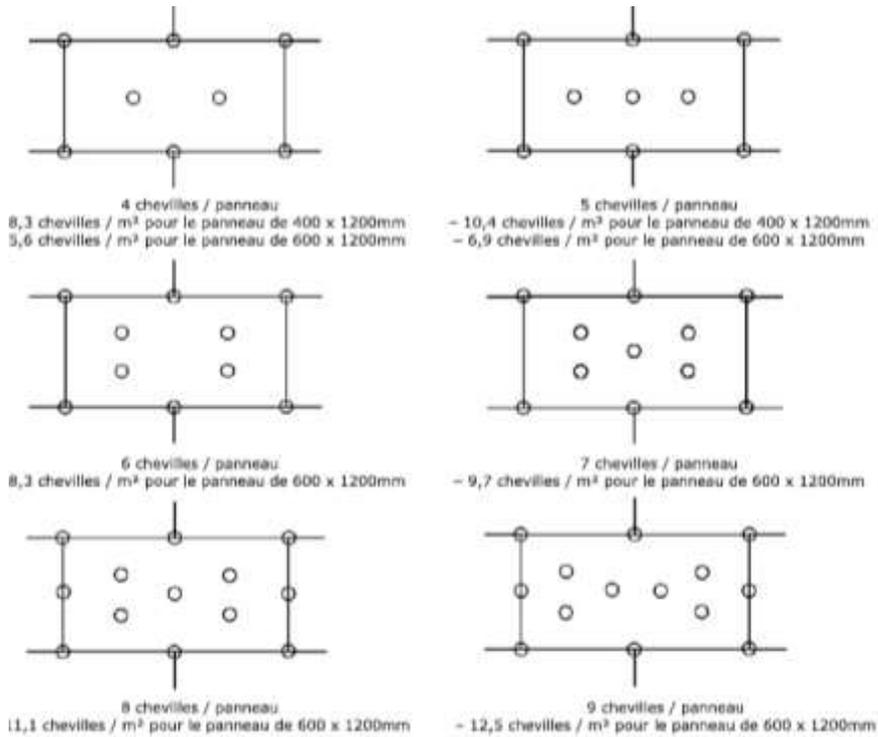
Exemple de plans de fixation sur CLT (2/2)
